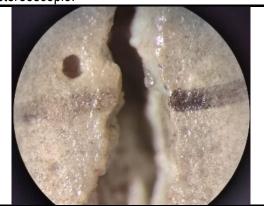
Medición de fisuras con el fisurometro.
